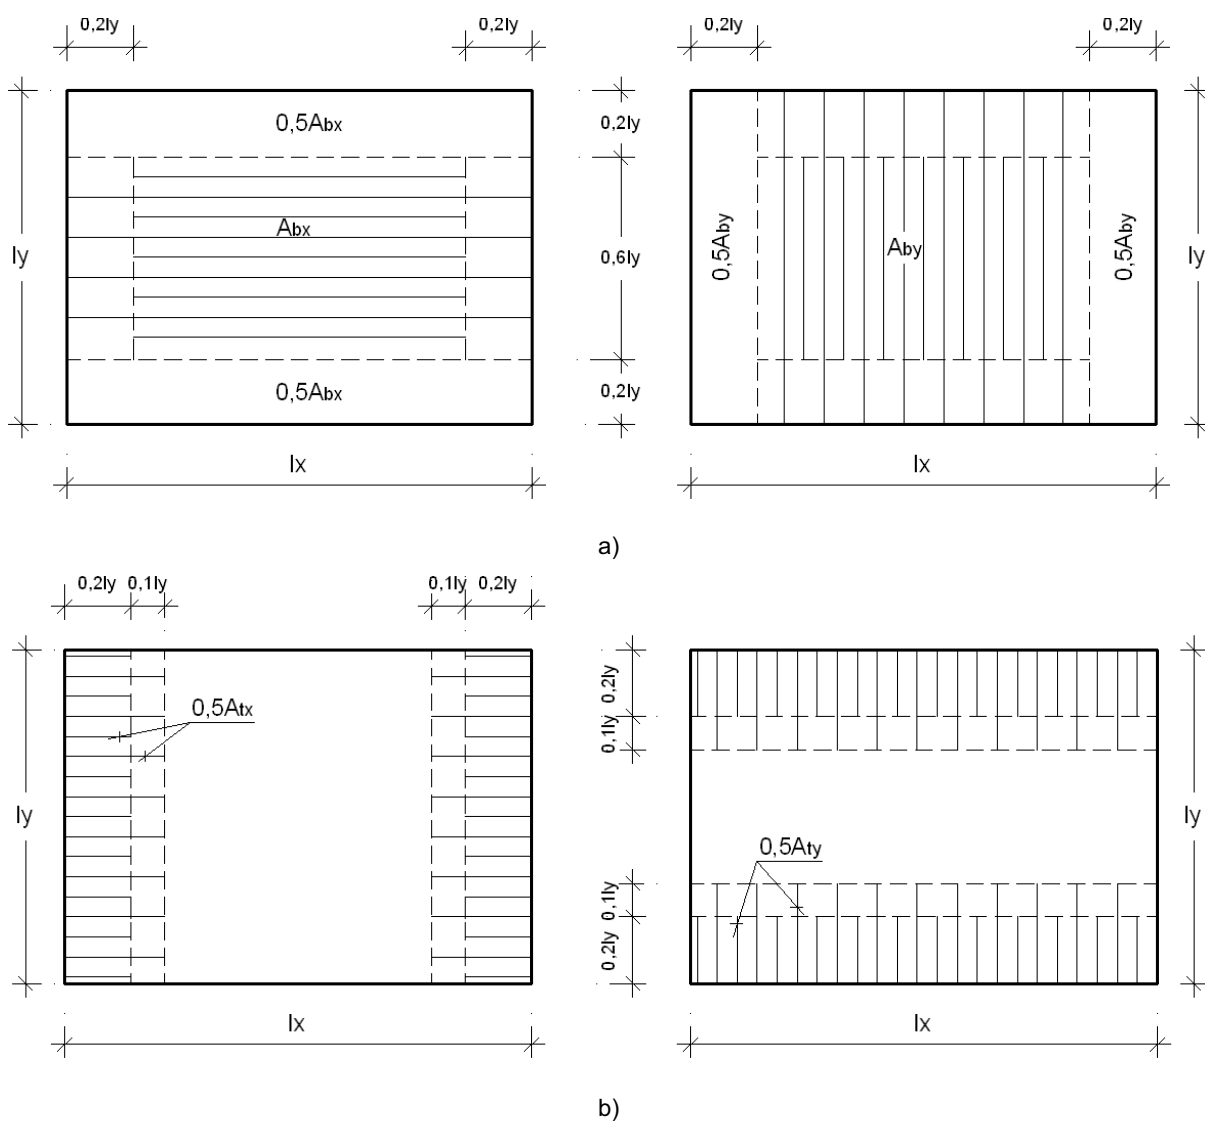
Disposição da armadura segundo as tabelas do Montoya (2000); a) Disposição da armadura inferior; b) Disposição da armadura superior
